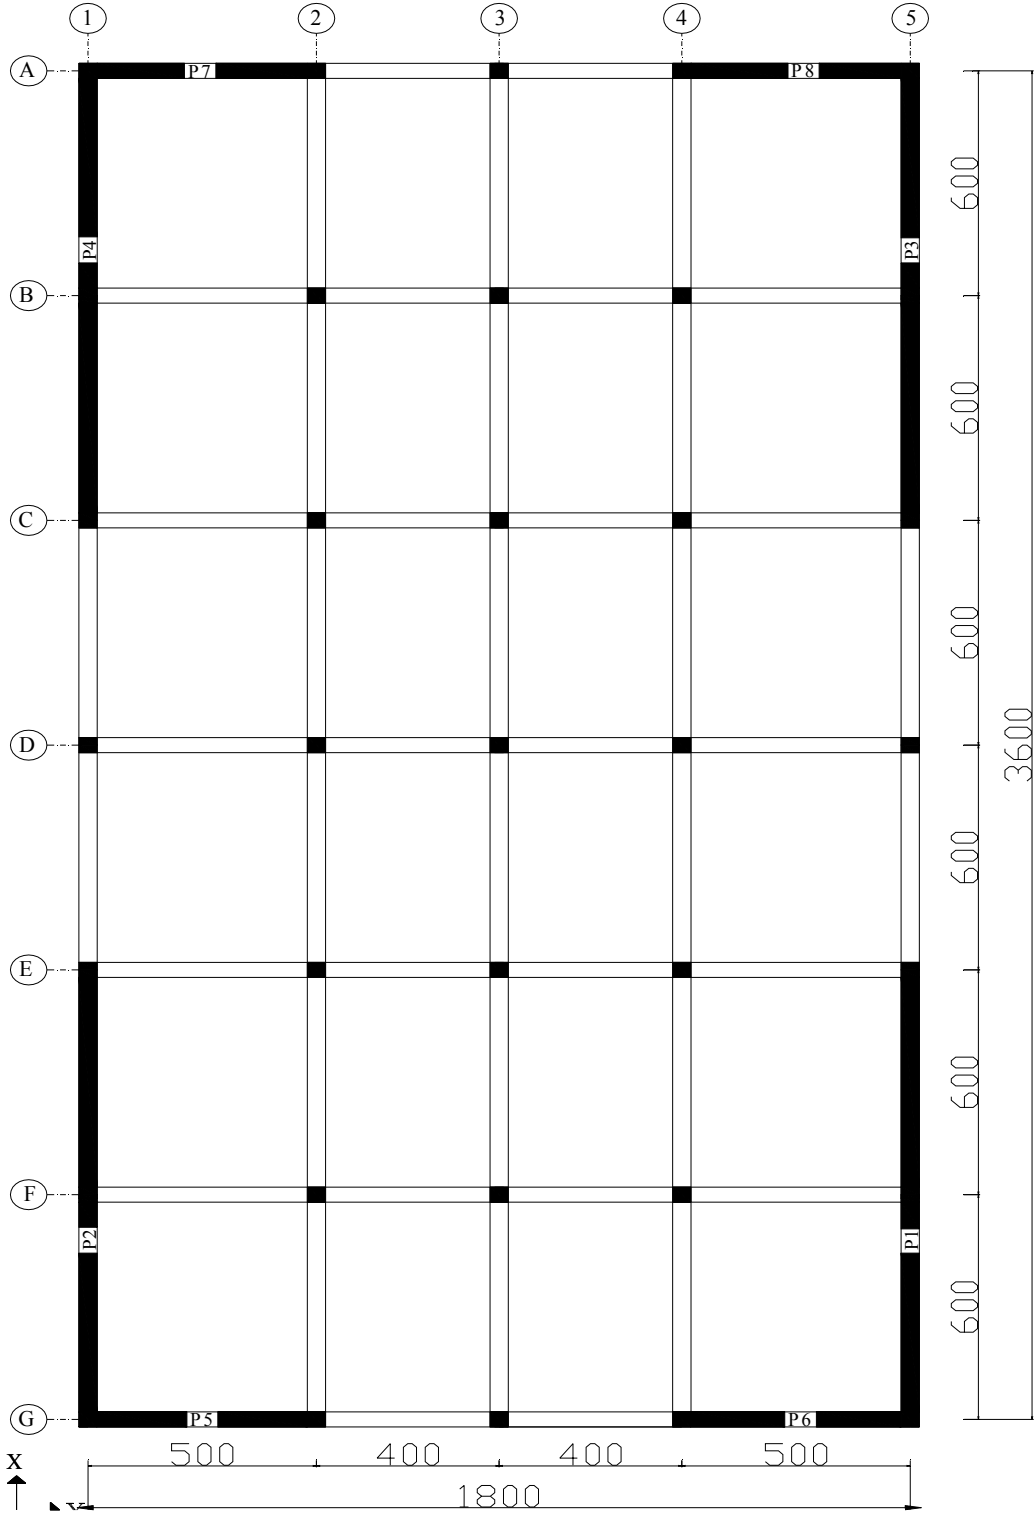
Örnek 5.11'in kat kalıp planı
